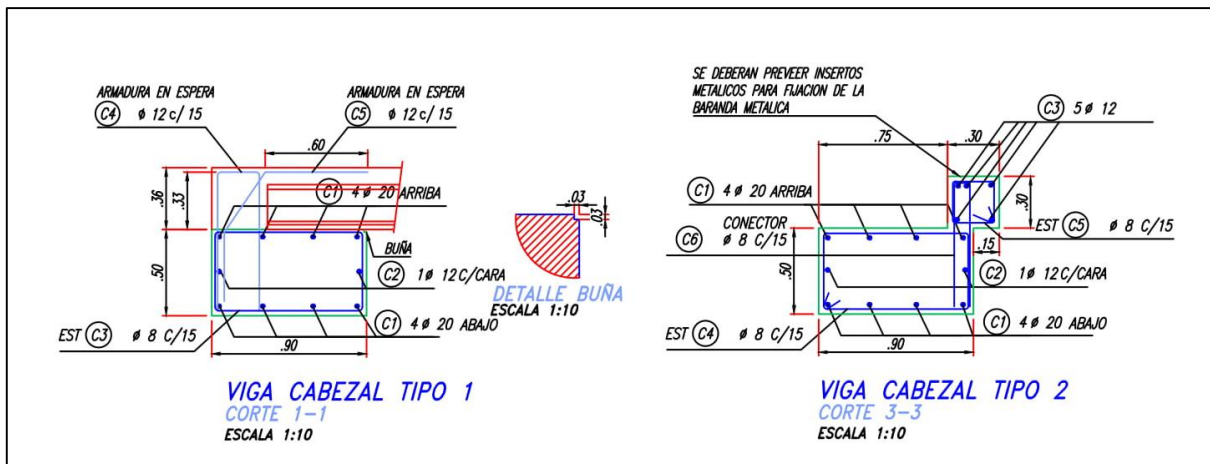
Sección transversal viga dintel longitudinal. (PLANO N° 27)
